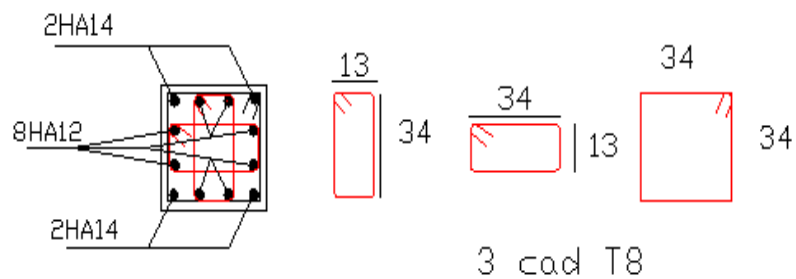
7: Ferrailage Poteau 40 × 40.
